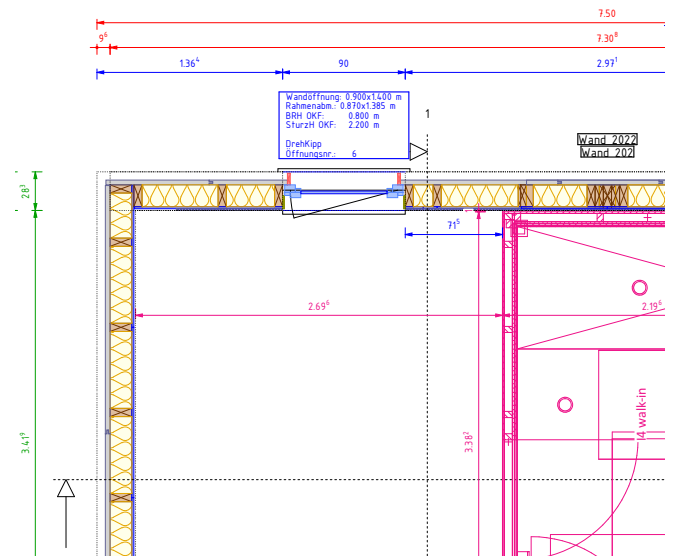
Grundriss eines Erdgeschosses als Ausschnitt aus einer Planung zum Holzrahmenbau, Bild: Holzbau Gehrmann GmbH
